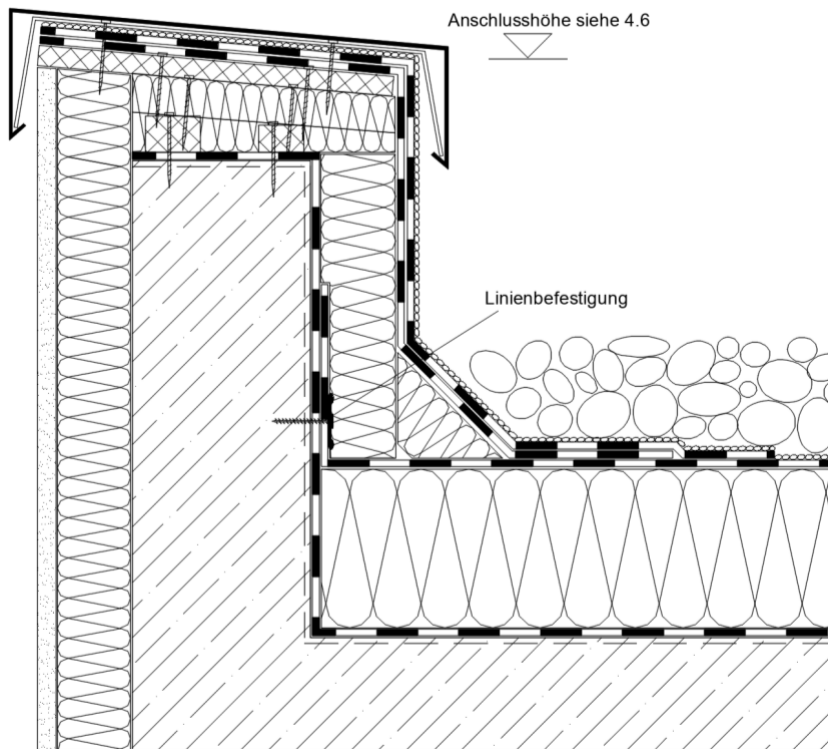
Starrer Dachrandabschluss – Ausführung mit Bitumenbahnen für einlagige Verlegung
